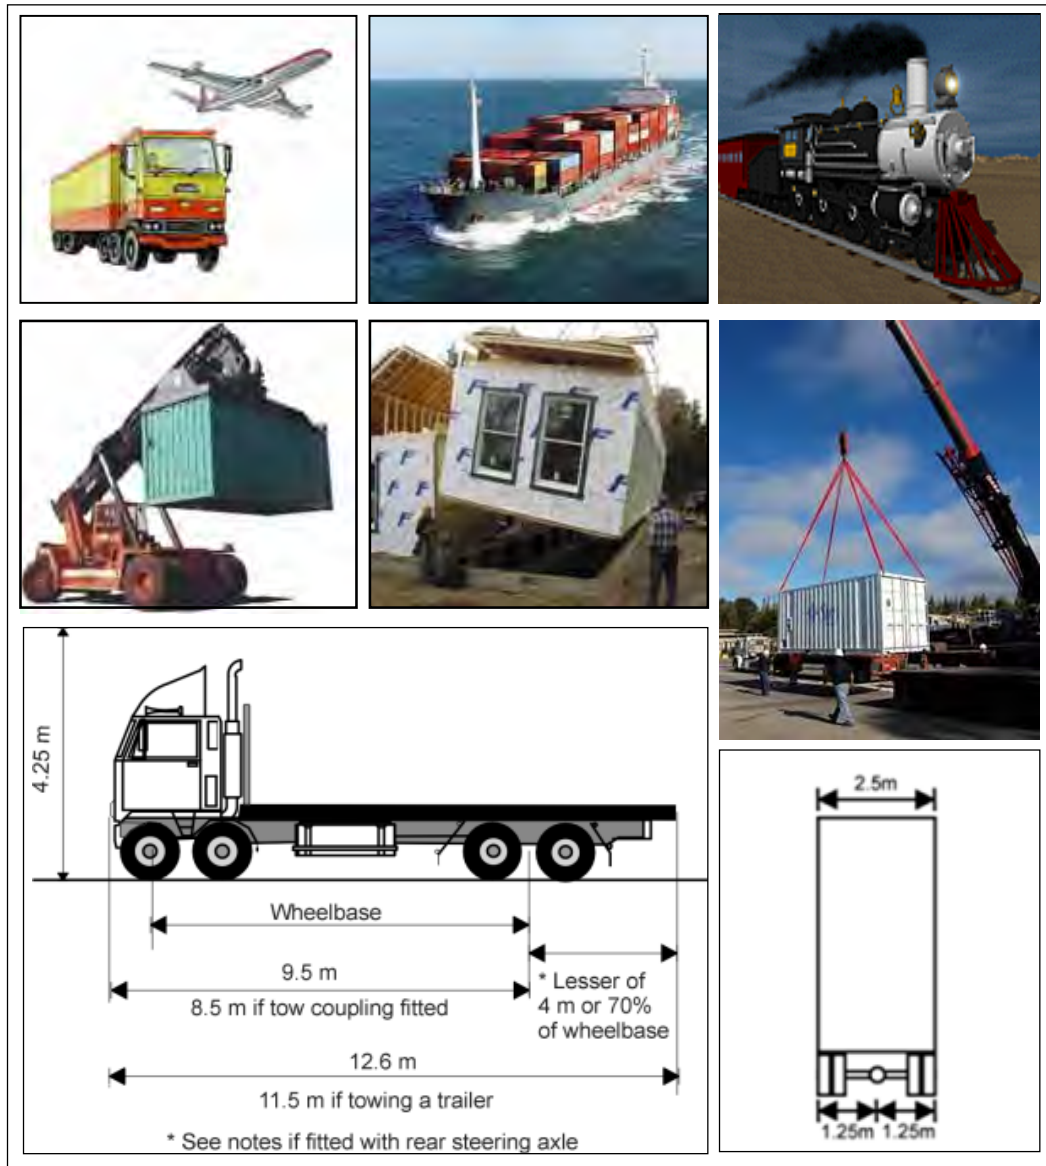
Transporte y montaje de edificaciones prefabricadas. Fuente
